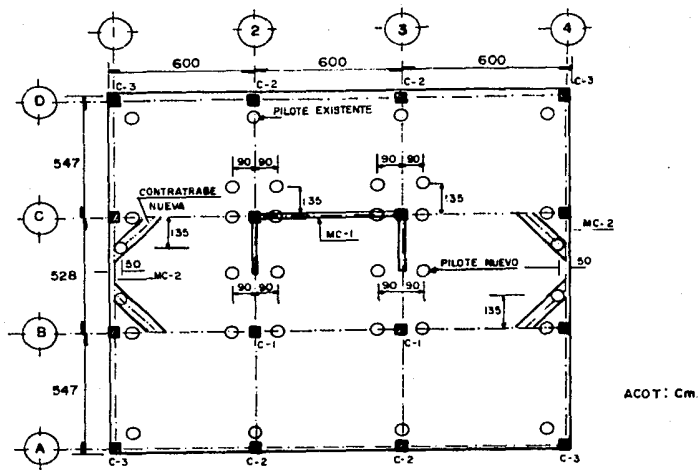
DISTRIBUCION EN PLANTA DE PILOTES DE PUNTA ADICIONALES
